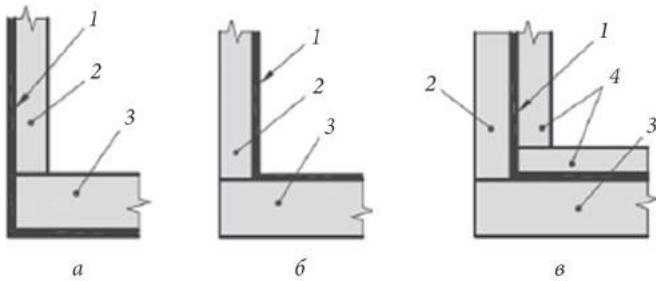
Расположение гидроизоляции в составе конструкционных элементов: *а* — наружная гидроизоляция; *б* — внутренняя гидроизоляция; *в* — гидроизоляция сэндвичного типа; 1 — гидроизоляционный материал; 2 — наружная стена сооружения; 3 — фундаментная плита; 4 — прижимные конструкции
